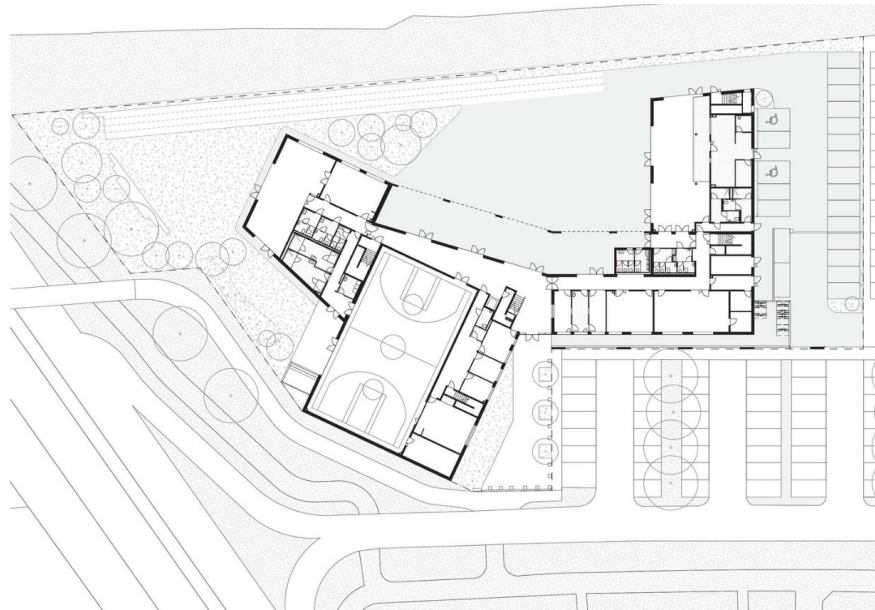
Генеральне планування та план 1-го поверху [2]
